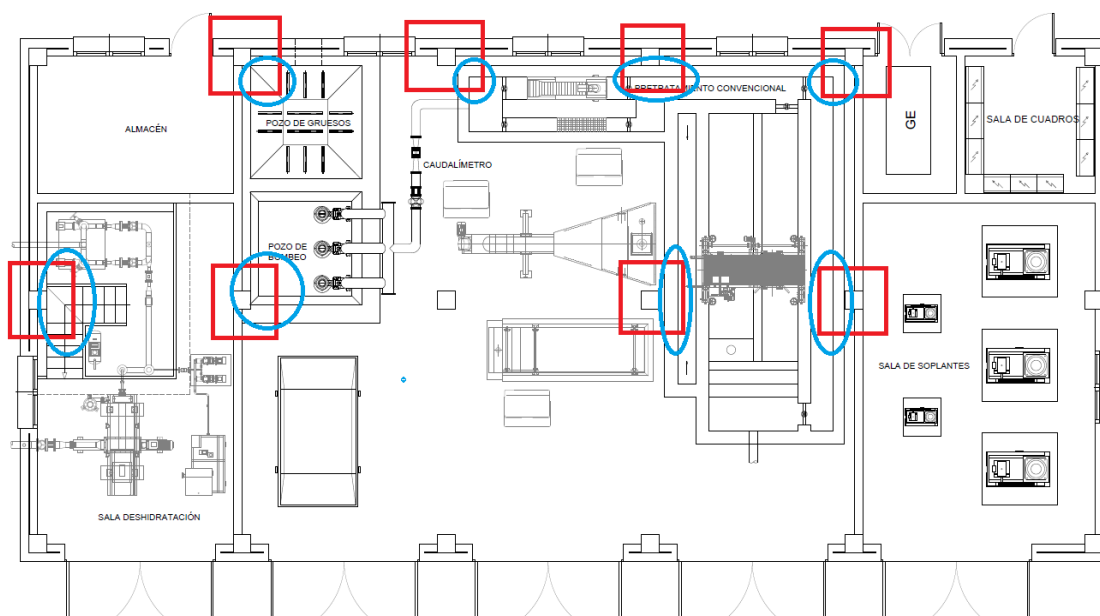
Planta del Edificio Industrial de Caraquiz.
